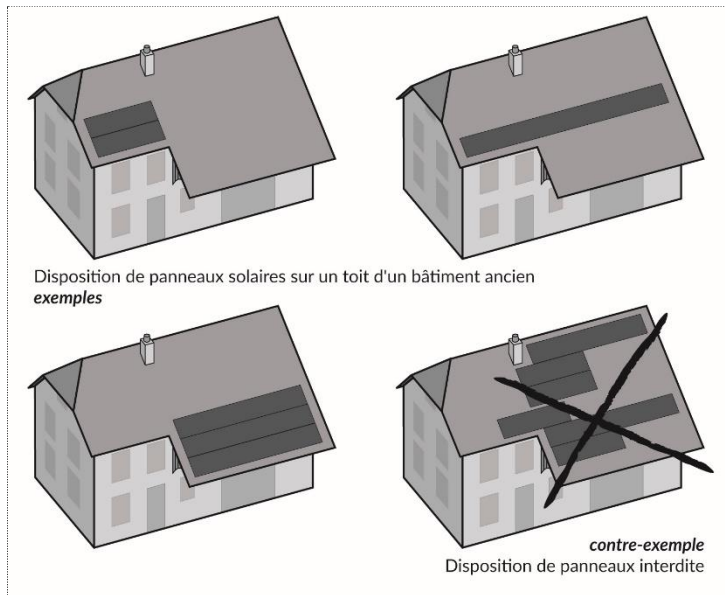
Schéma de positionnement de panneaux solaires sur un bâti ancien.
